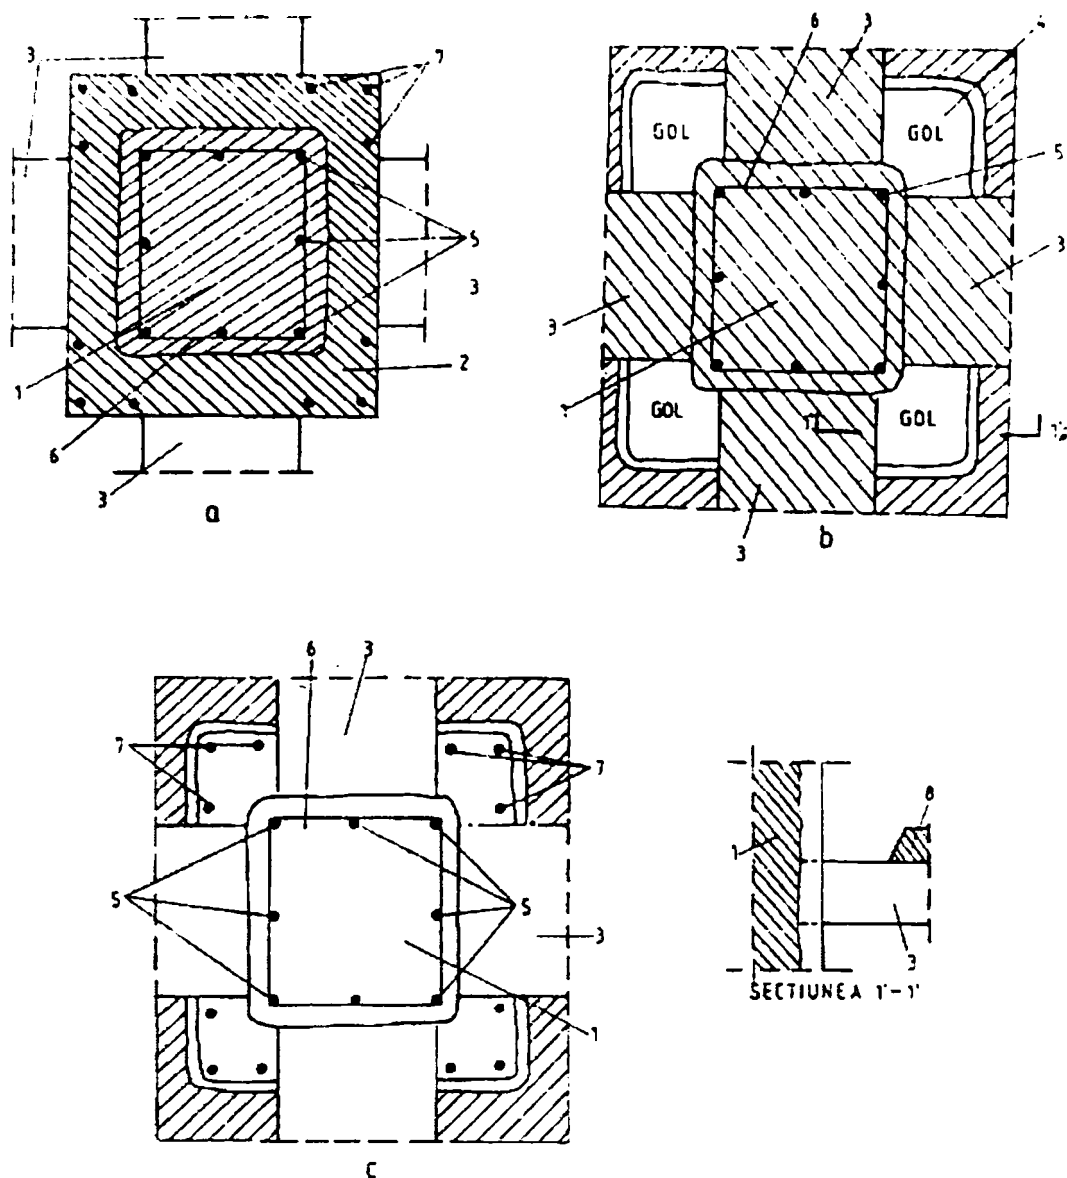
Trecerea camasuielii stilpului prin placa: a - sectiune 1-1.; b - sectiune 3-3 - spargera placii in dreptul stilpilor ; c -sectiune 3-3- dupa turnarea betonului.
